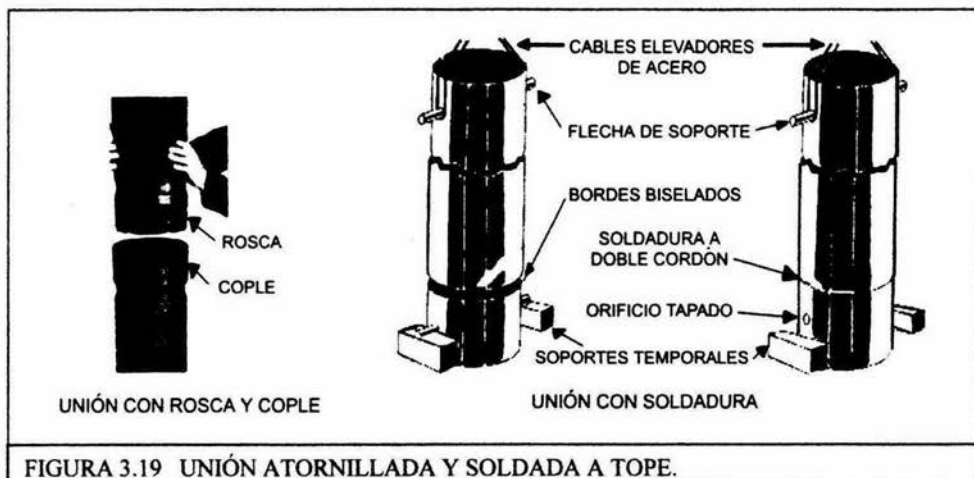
UNIÓN ATORNILLADA Y SOLDADA A TOPE.
